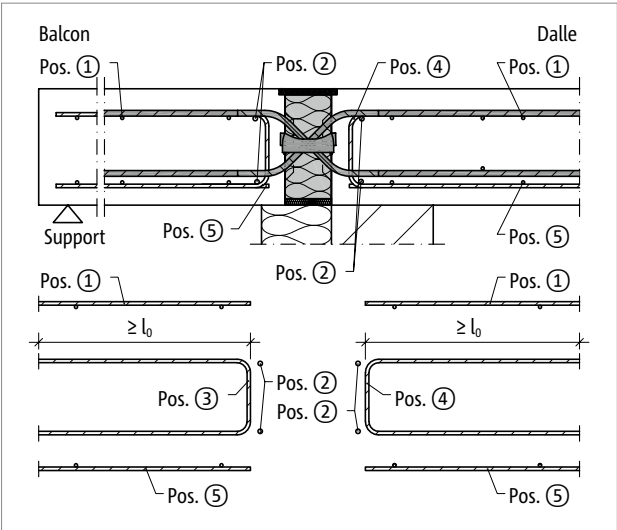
Schöck Isokorb® T Type Q-E-VV : Renforcement sur site
